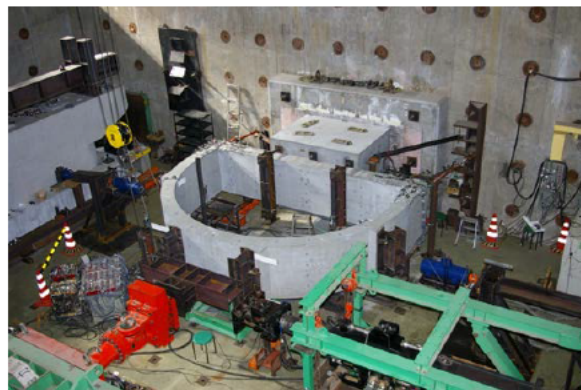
載荷状況写真 (場所打ちアーチの例, 供試体を水平に設置)
